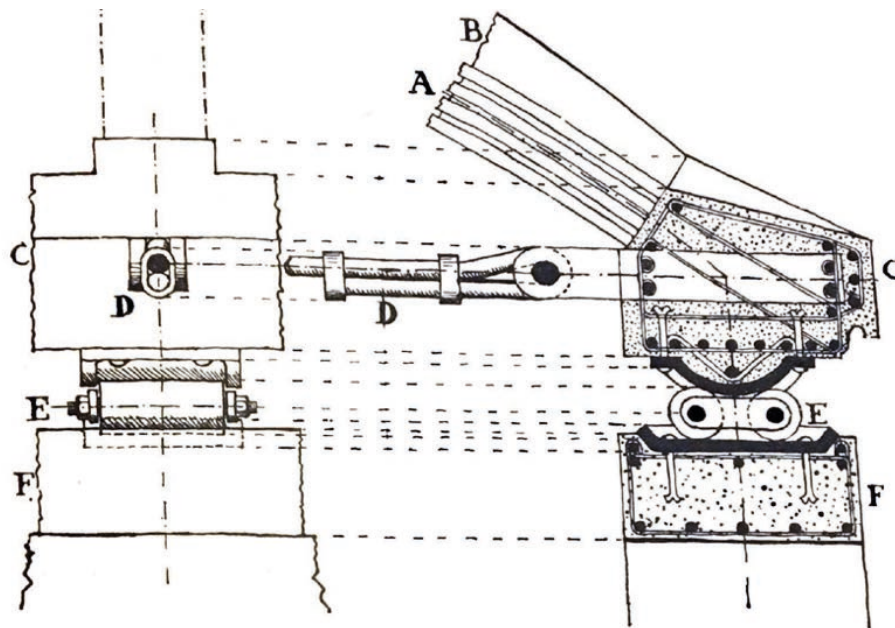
Apoyo de giro y deslizamiento (detalle de la fig. 46):
